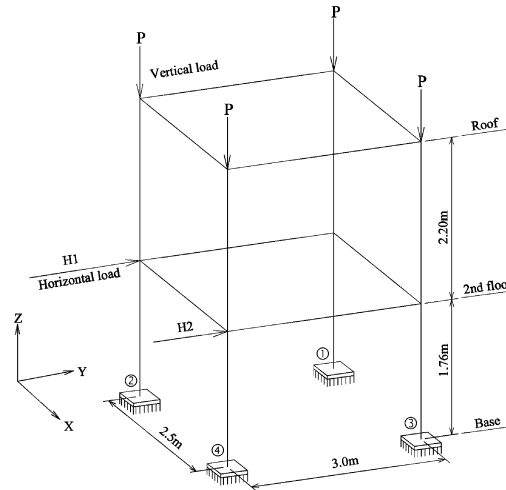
Pórtico tridimensional rígido ensayado por Kim y otros (2003)
